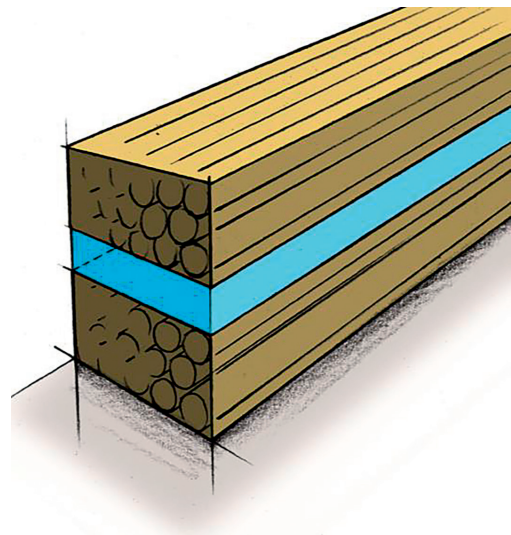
Timber Structures 2.0: Brettschichtholz und CLT
